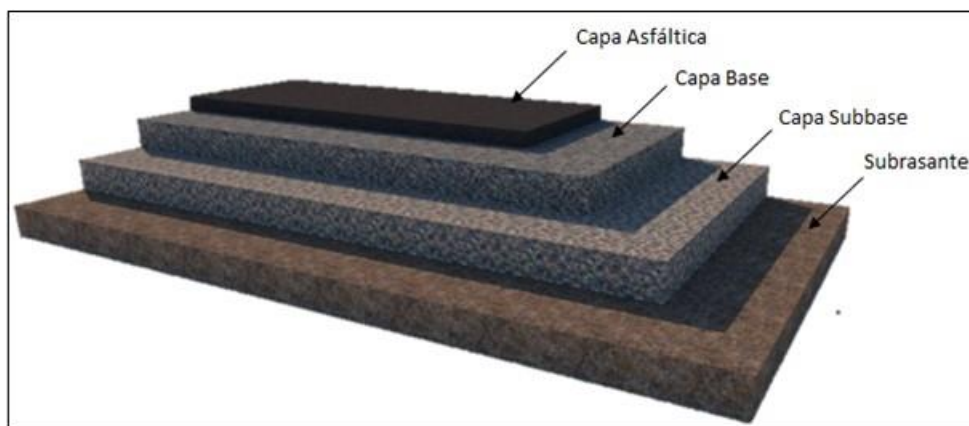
Elementos estructurales del pavimento - (Farinango Bilbao, 2014)
